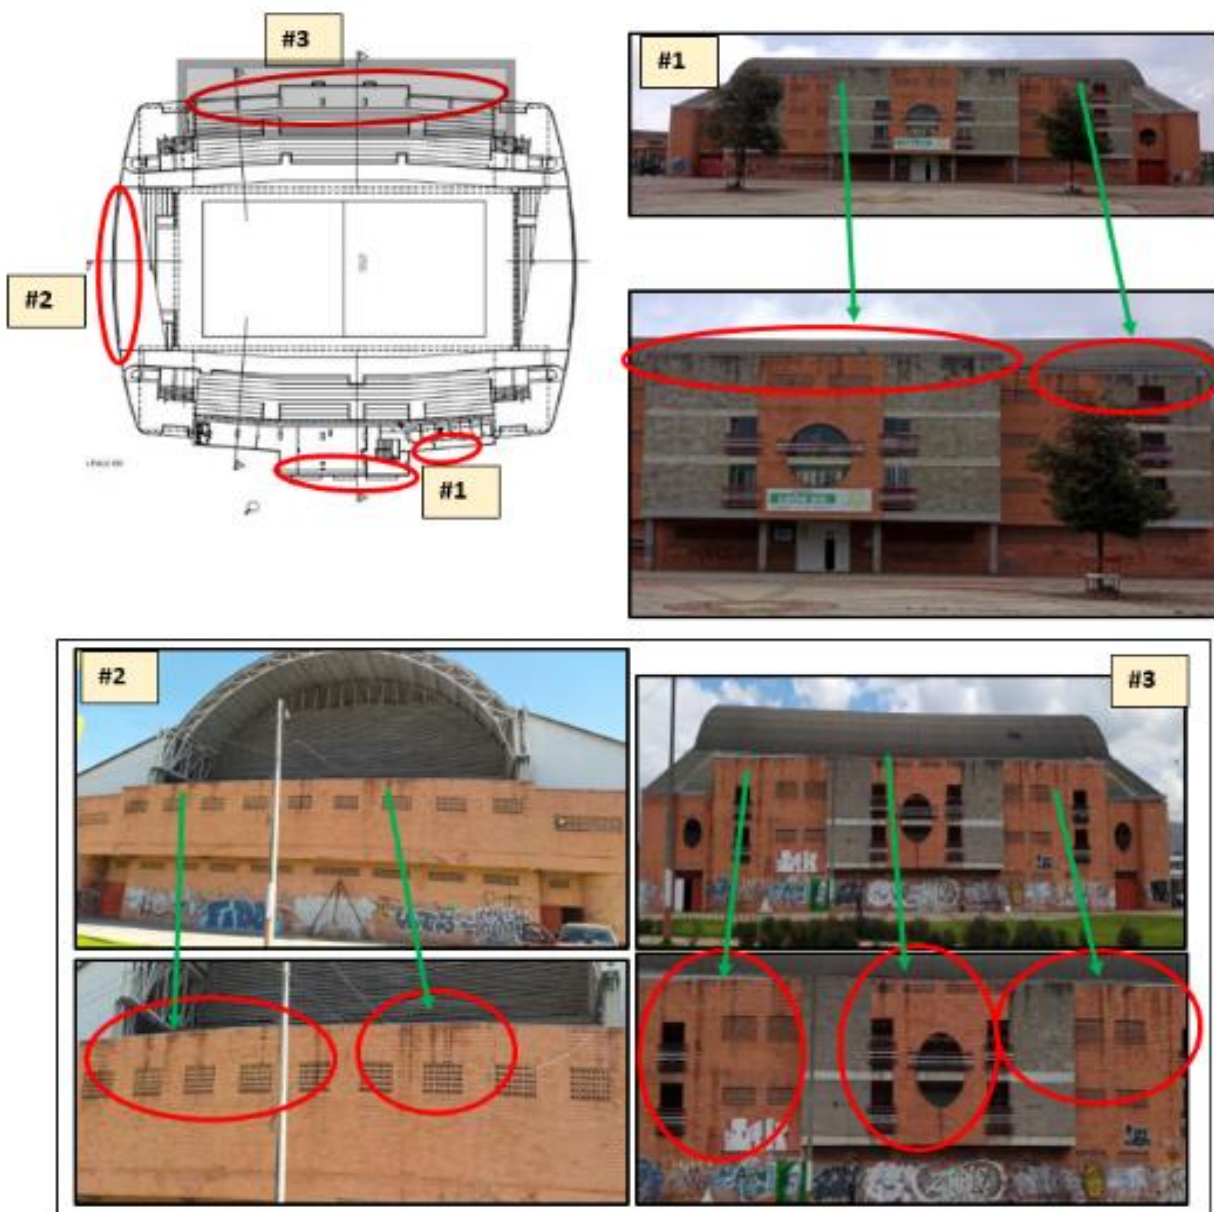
Lesión Desprendimiento del Enchape Planta segundo piso.
